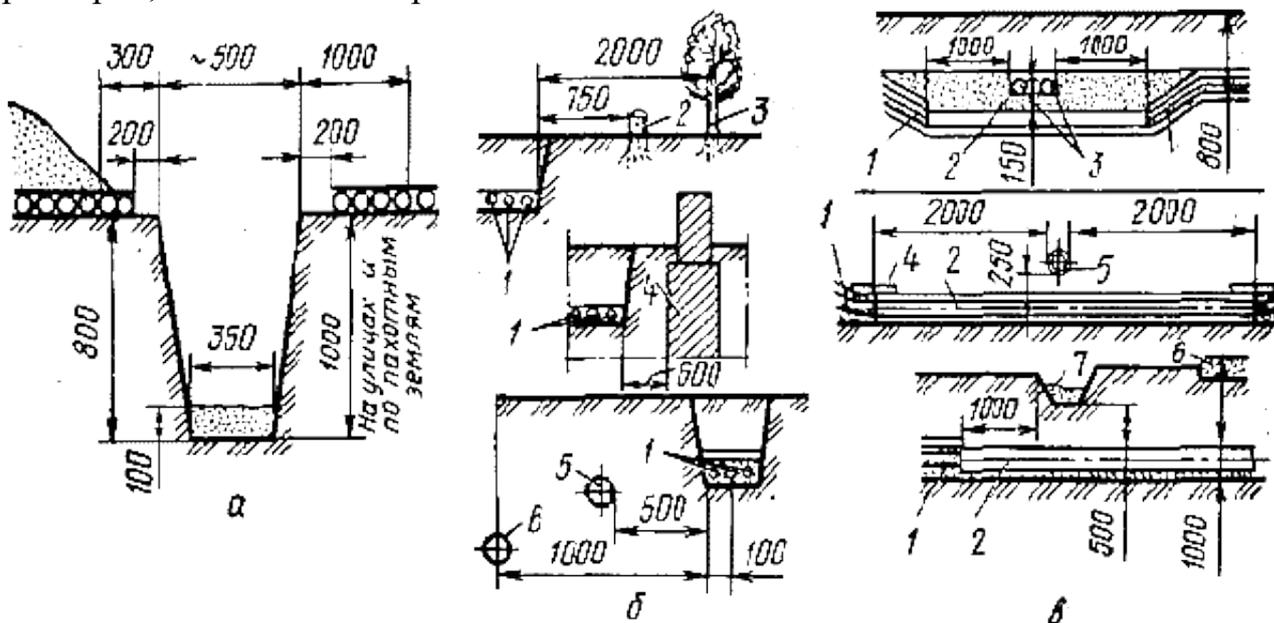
Подготовка трассы для прокладки кабелей в земле: а - размеры траншеи для кабеля; б - минимальные расстояния при сближении силовых кабелей с насаждениями и сооружениями: 1 - кабель; 2 - кустарник; 3 - дерево; 4 - фундамент; 5 - водопровод; 6 - газопровод низкого давления; в - минимальные габаритные размеры при пересечении силовыми кабелями подземных сооружений и дорог: 1 - кабель; 2 - защитная труба; 3 - кабель связи; 4 - кирпичное покрытие; 5 - трубопровод; 6 - дорога; 7 - кювет
